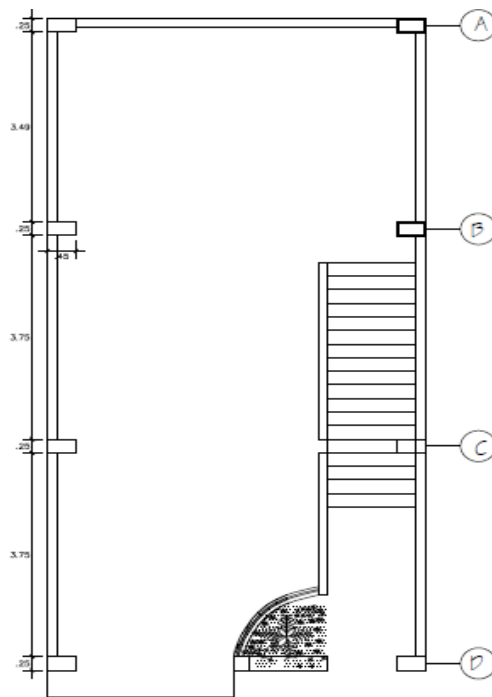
Esquema en planta vivienda autoconstruida 1
